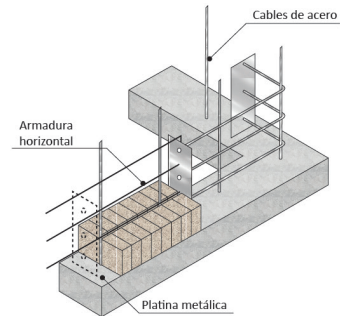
Sistema unión de bloque, casa lienzo de barro.
